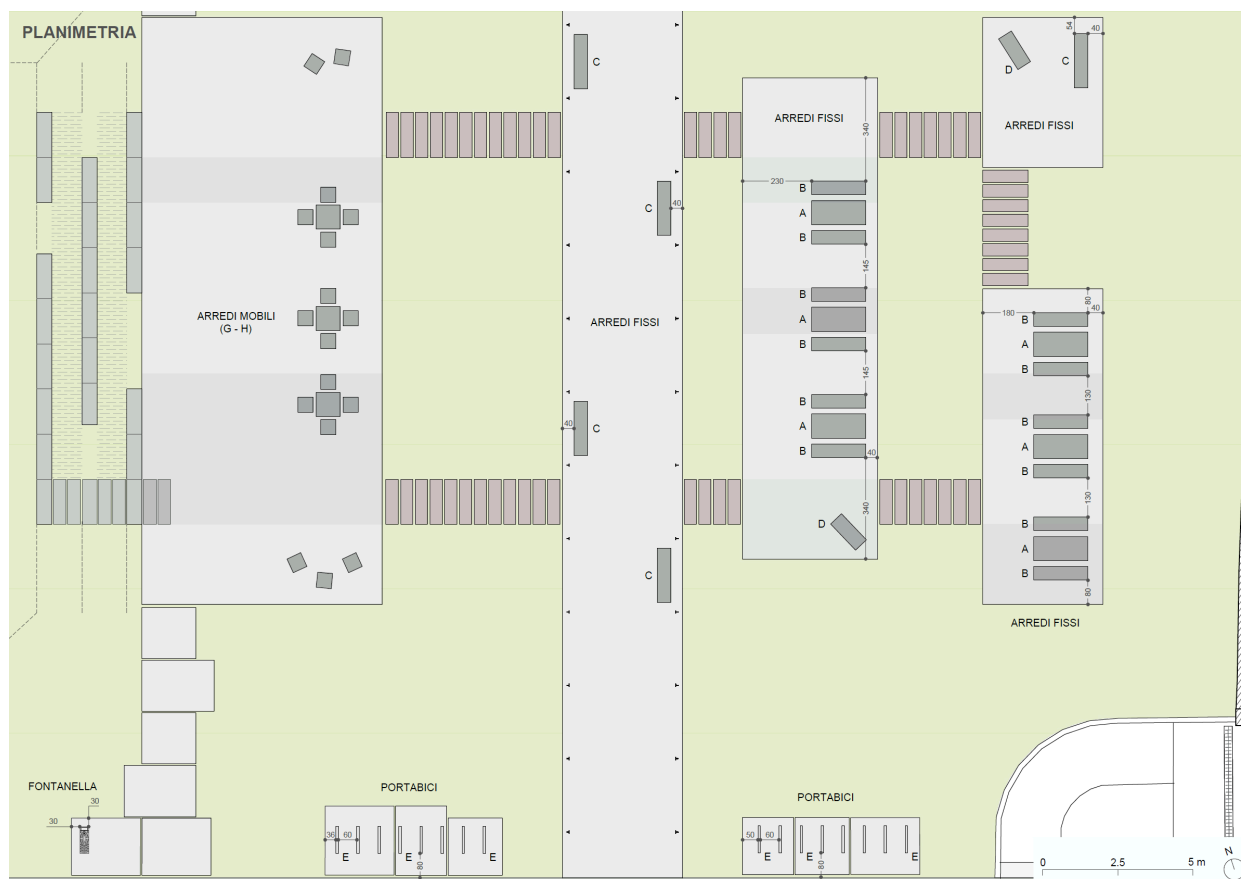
Planimetria con indicazione degli arredi e della tipologia (fissi e mobili). Estratto dalla tavola T9.
